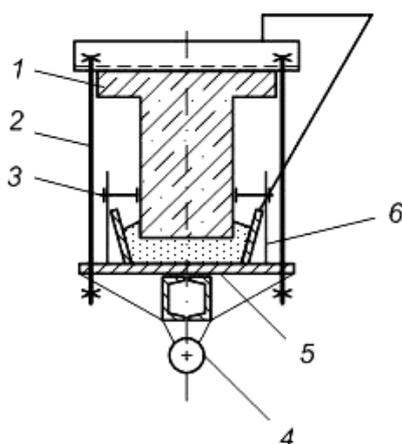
Усиление растянутой зоны подкрановой балки с использованием блок-формы: 1 – балка; 2 – подвеска; 3 – прижимной винт; 4 – вибратор; 5 – блок-форма; 6 – бетон усиления
